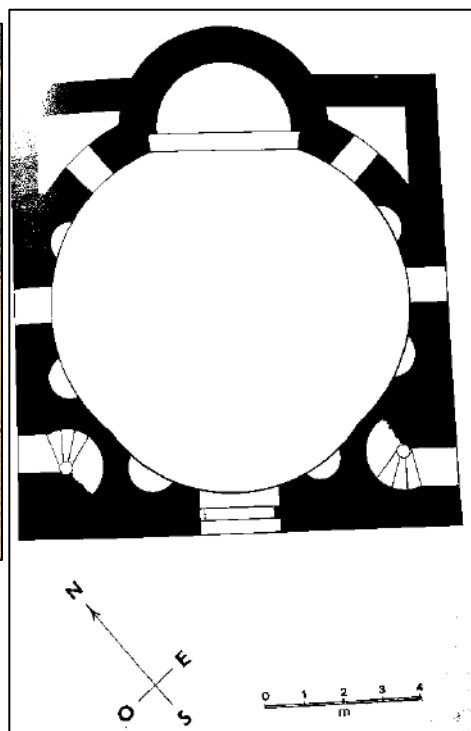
Planta església de la Trinitat, Codalet. Es pot observar la planta quadrada dels murs exteriors. Font: VIGUÉ, 1975: 297.
